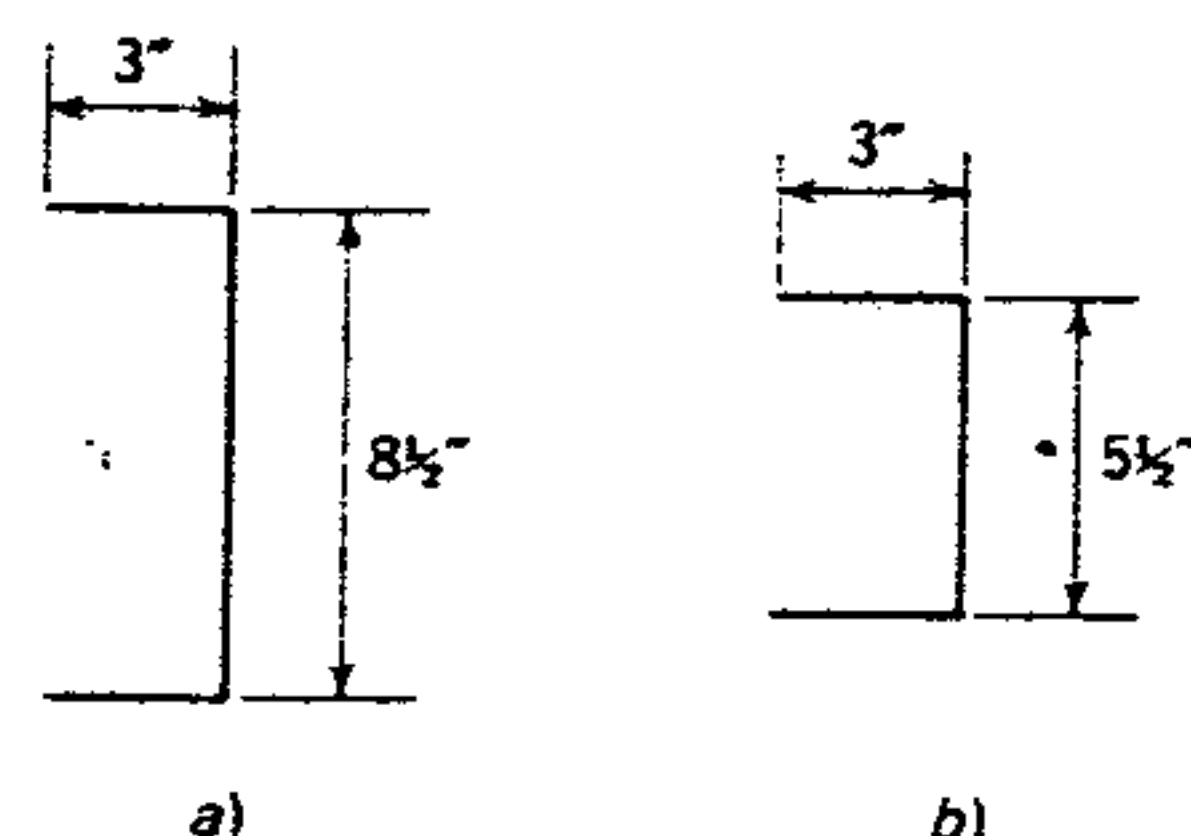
Soldadura del ángulo de conexión.
